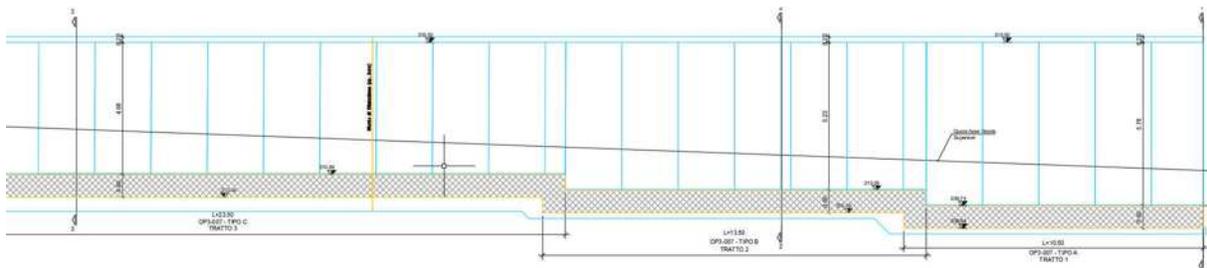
Muro OP3-007 - Stralcio prospetto
